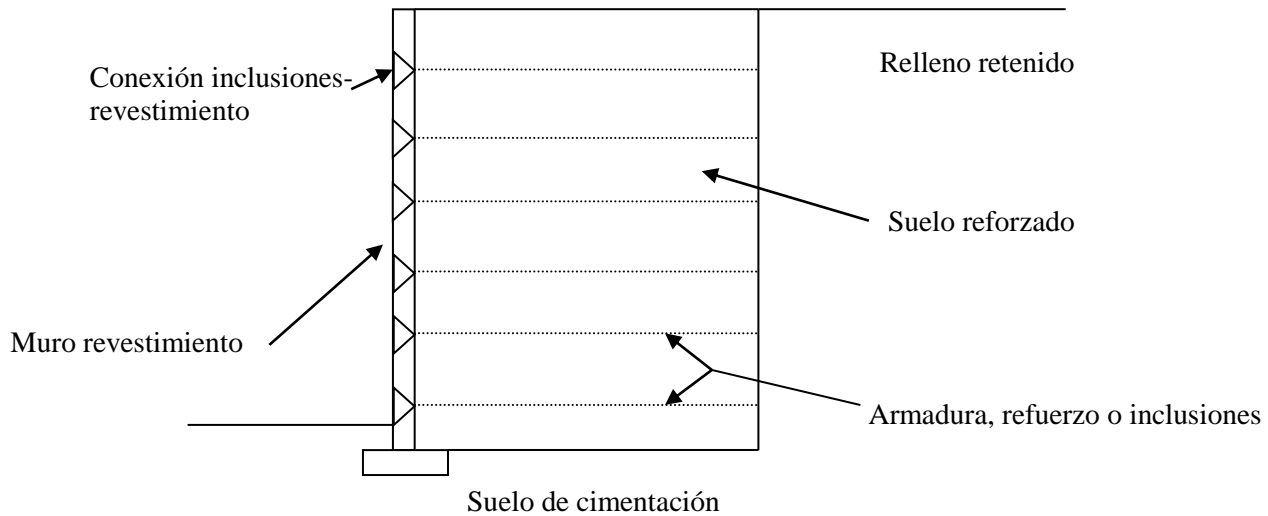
Componentes de un muro mecánicamente estabilizado (FHWA, 2009)
